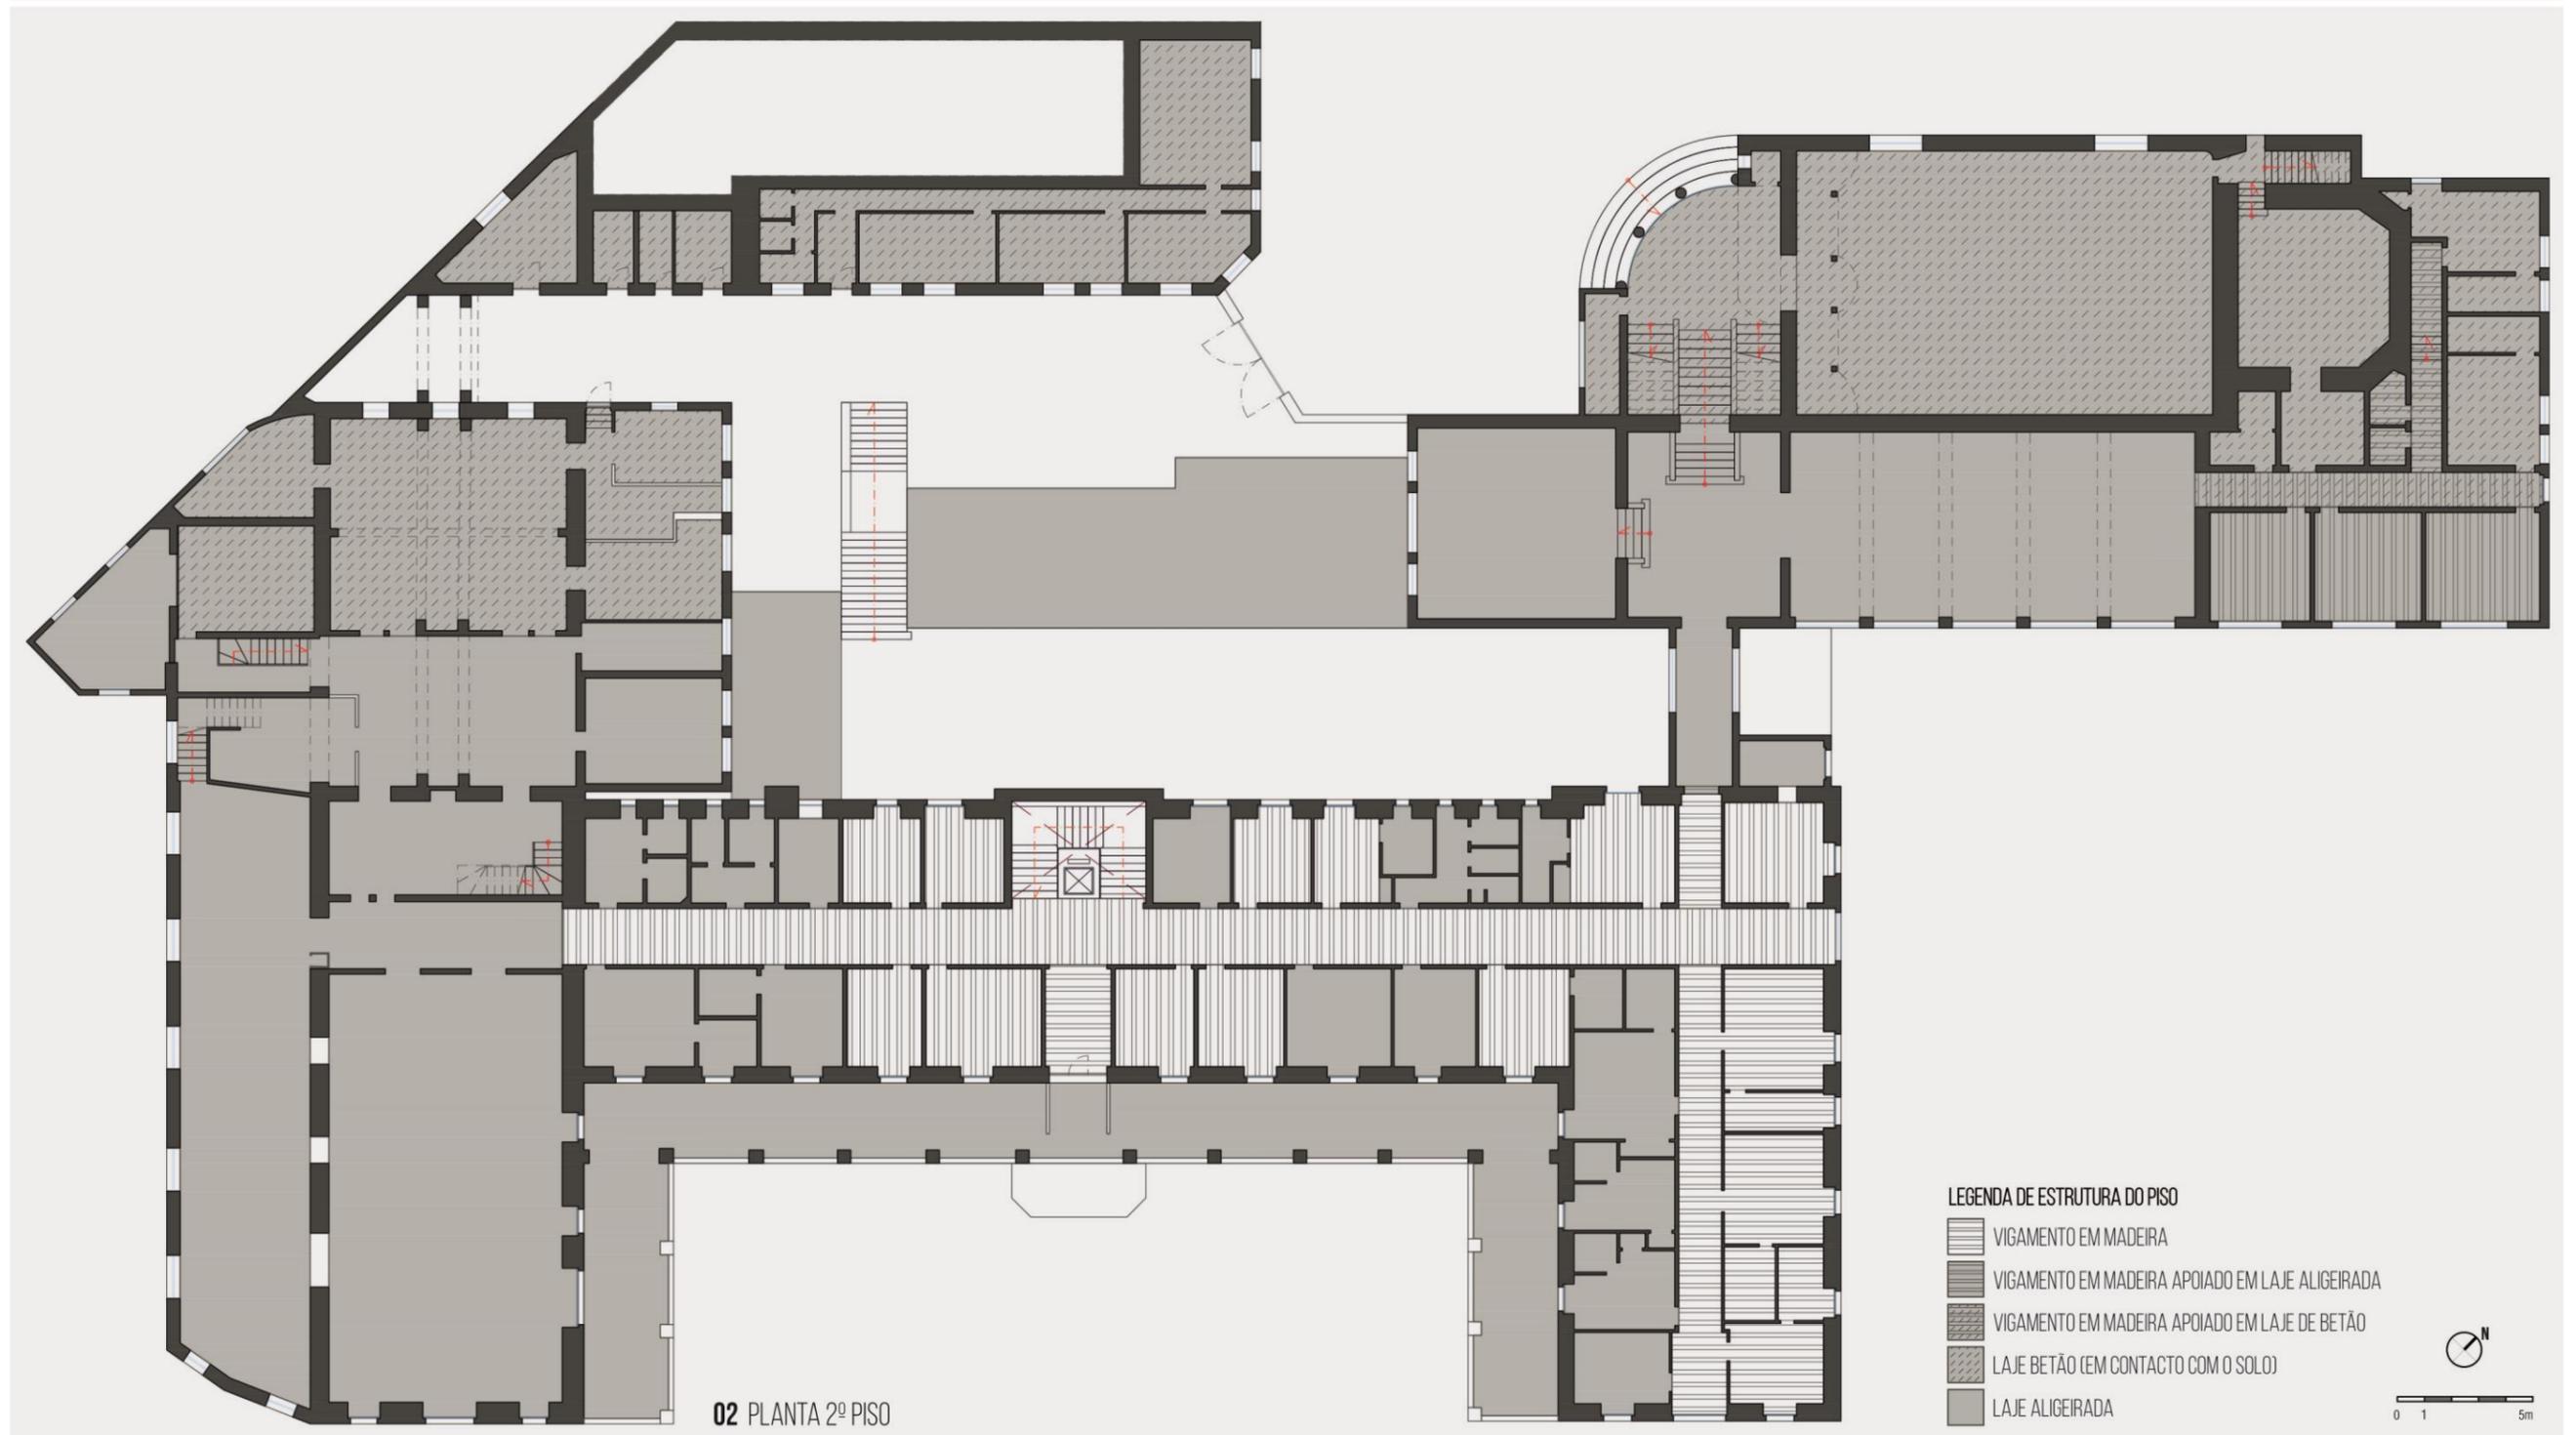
Planta de Estrutura do Pavimento – 2º Piso
